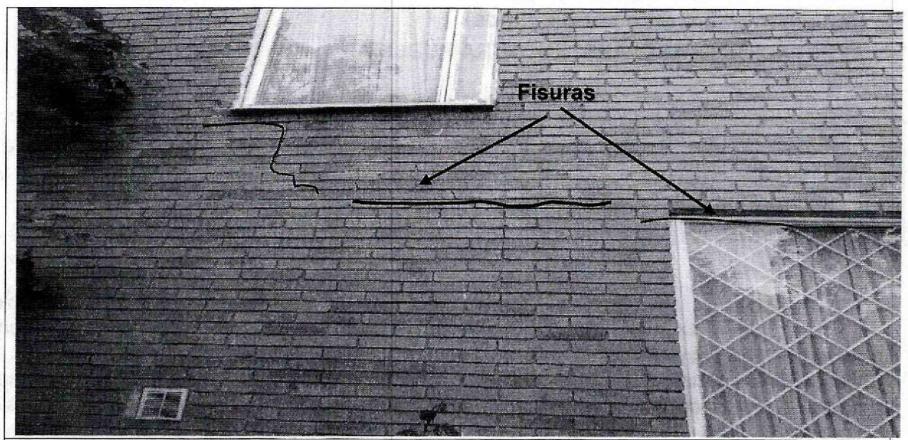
Detalle Fisura longitudunal en muro exterior costado Norte del predio.
